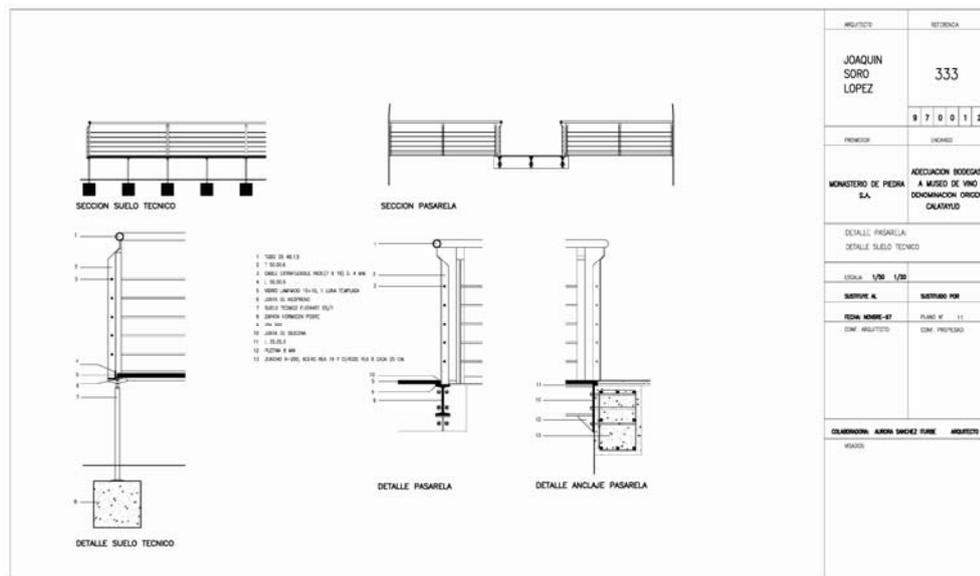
([JAS] Proyecto Nov 1997, plano 11) DETALLE PASARELA. DETALLE SUELO TÉCNICO
